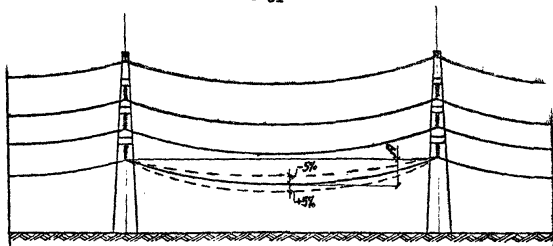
Нормы и допуски на монтаж проводов.
